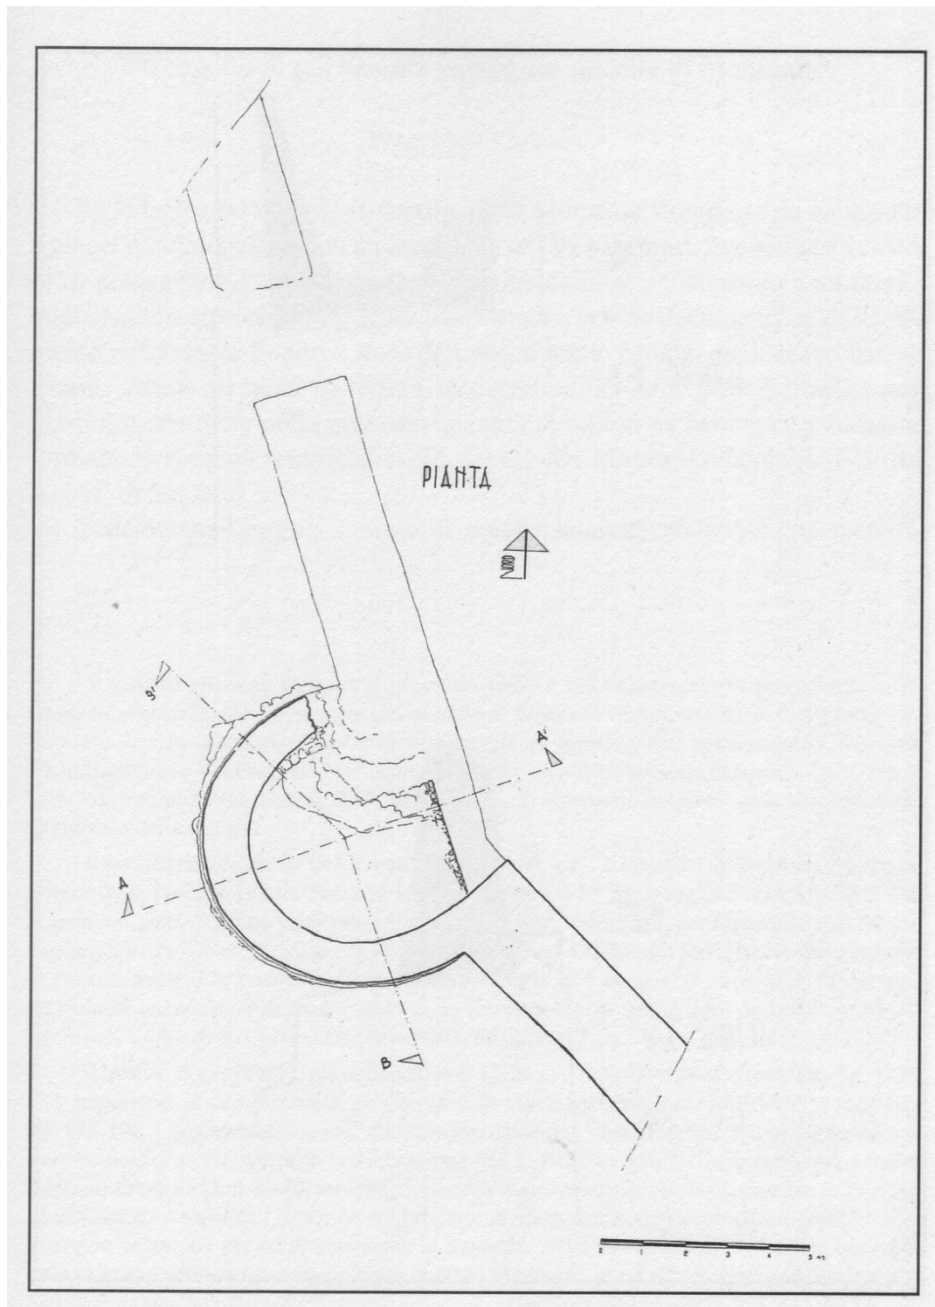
Planimetrie des halbrunden Turms C (aus: Uccheddu 2004, S. 239).
